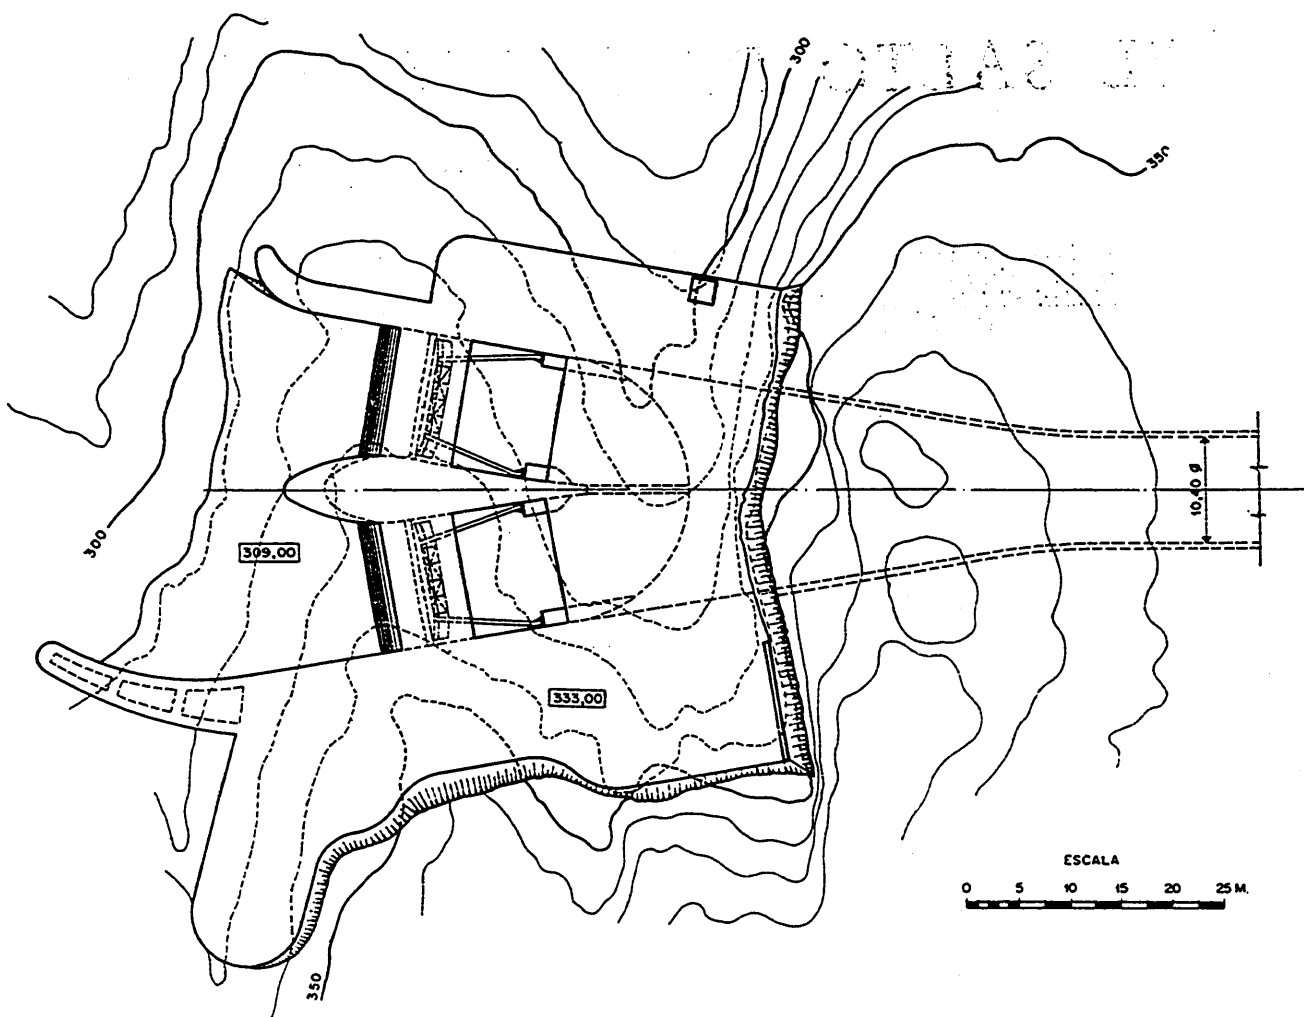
Túnel aliviadero. Planta de la embocadura.
